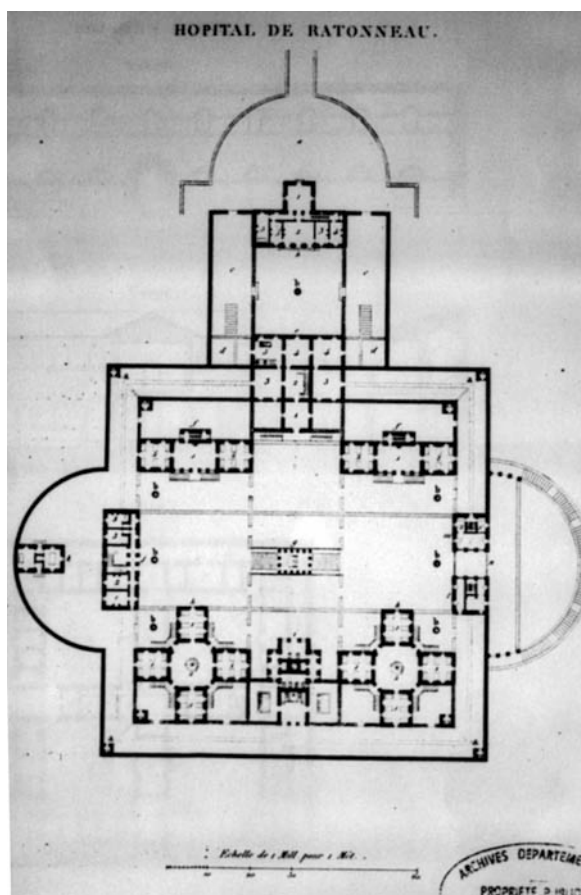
Plan d'après la statistique du département. Photo H. Daret.
